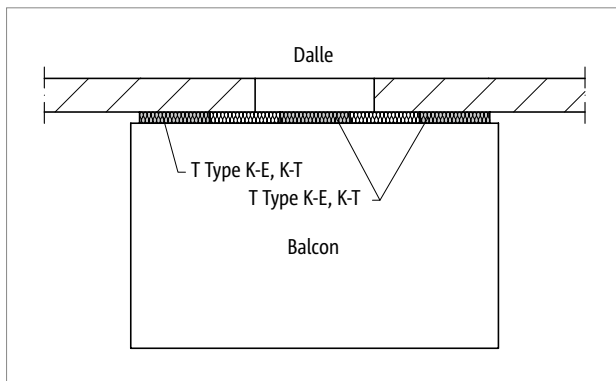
Schöck Isokorb® T Type K-E, K-T : Balcon en porte-à-faux
